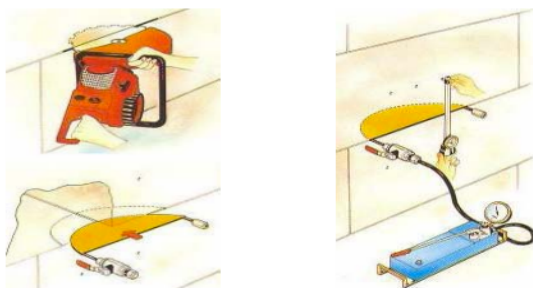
Schema della fase d'installazione e della disposizione dei sensori nel test di martinetto piatto singolo
